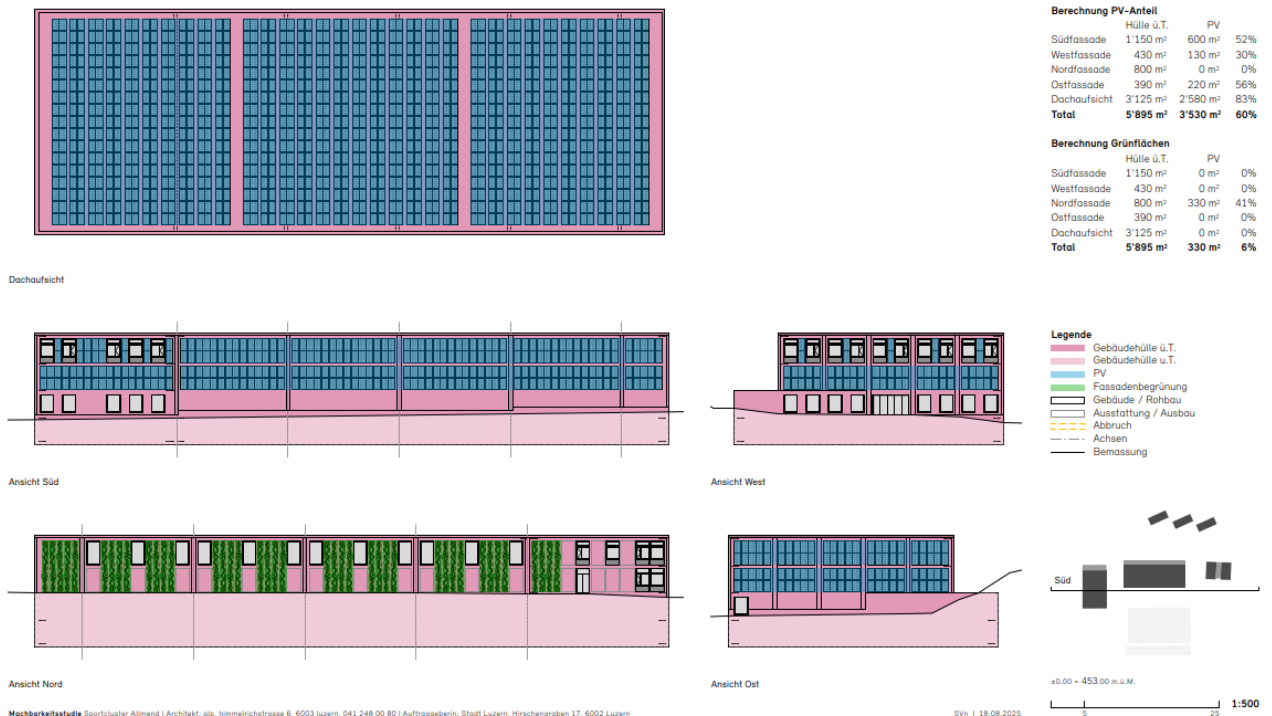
Grundriss und Ansichten - Planungsstand vom 18.08.2025
